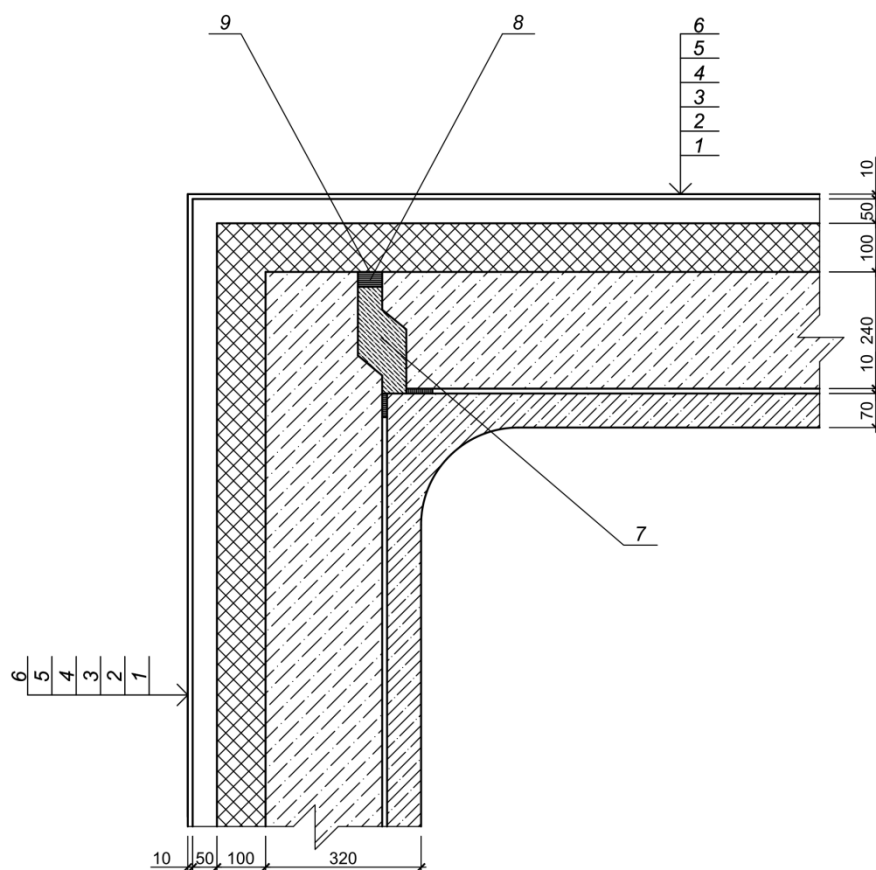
Схема проектного решения угла наружных стен (крепление облицовки фасада условно не показано):
